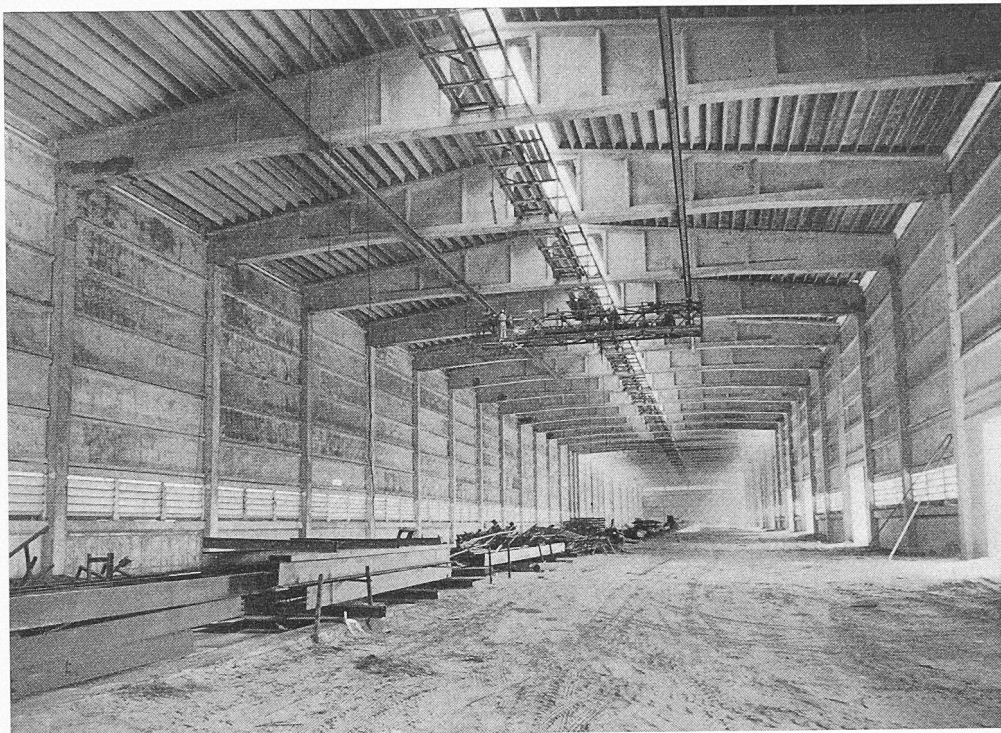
Vollständig vorfabriziertes Industriegebäude. Die sehr verbreiteten T-Träger bilden die Dachelemente. Photo Modern Concrete Magazine, Chicago, Illinois
